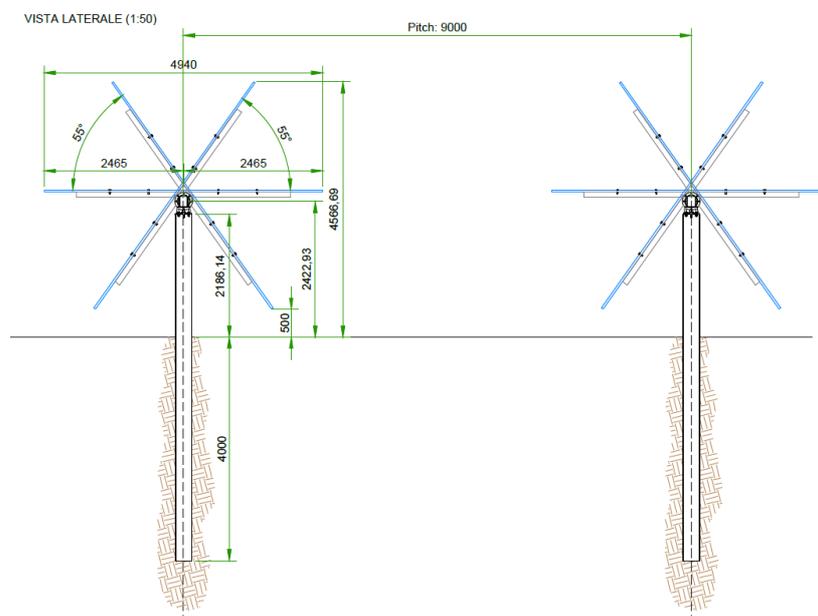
Particolare strutture tipo trackers di sostegno moduli
